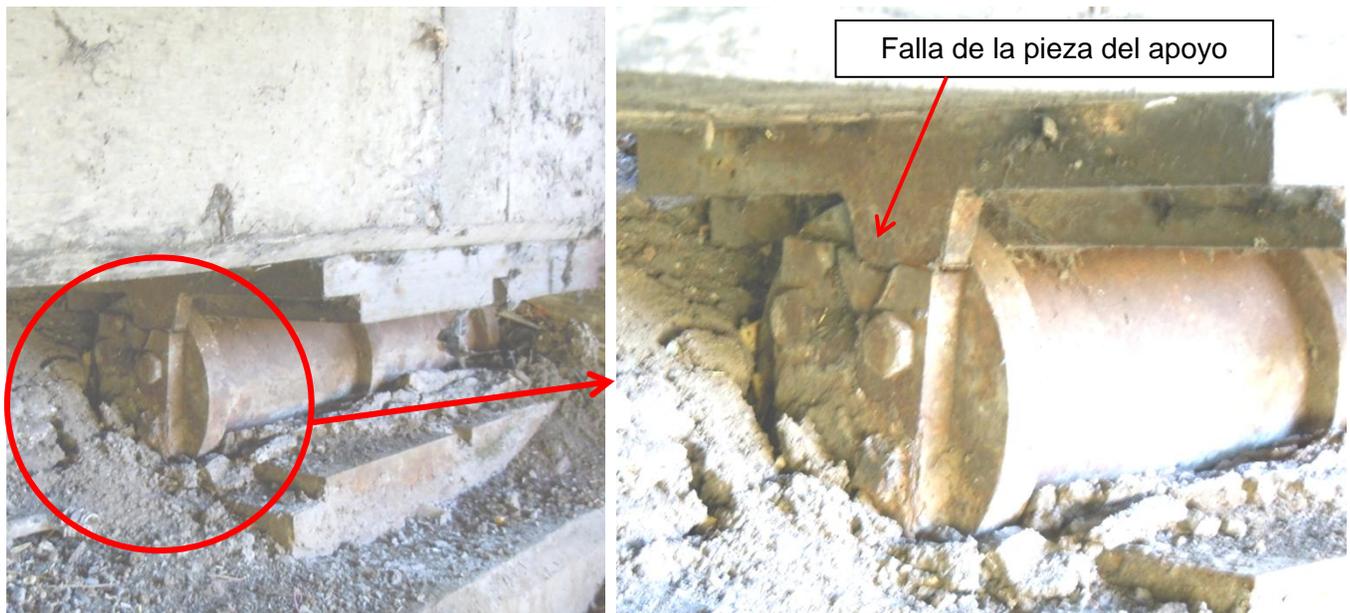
Falla de la pieza para restringir el movimiento excesivo en apoyo sur sobre bastión E.
